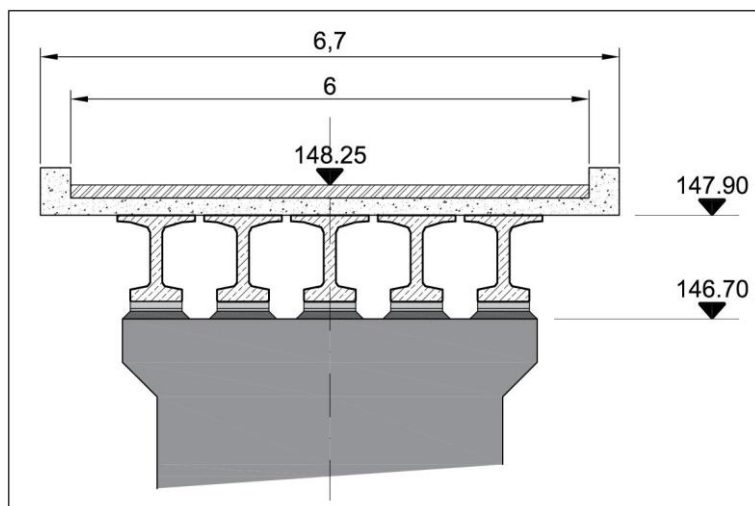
Sezione dell'impalcato dei ponti a coronamento
